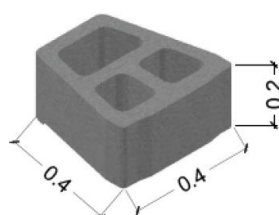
Dimensões do bloco pré-moldado (MIRMORADI, 2015)
